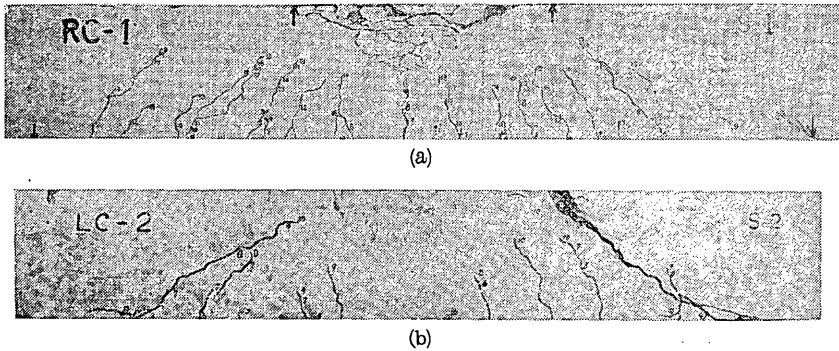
鉄筋コンクリートはりの荷重試験後のひびわれの状態
